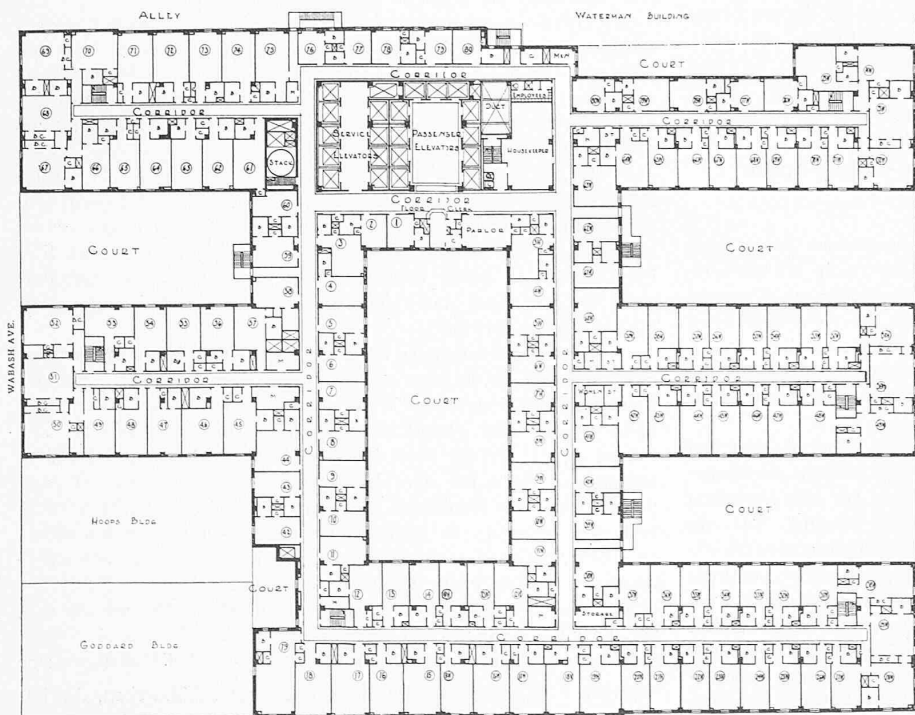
Grundriss eines typischen Hotelgeschosses (10. bis 23. Geschoss). — Masstab etwa 1 : 800.
